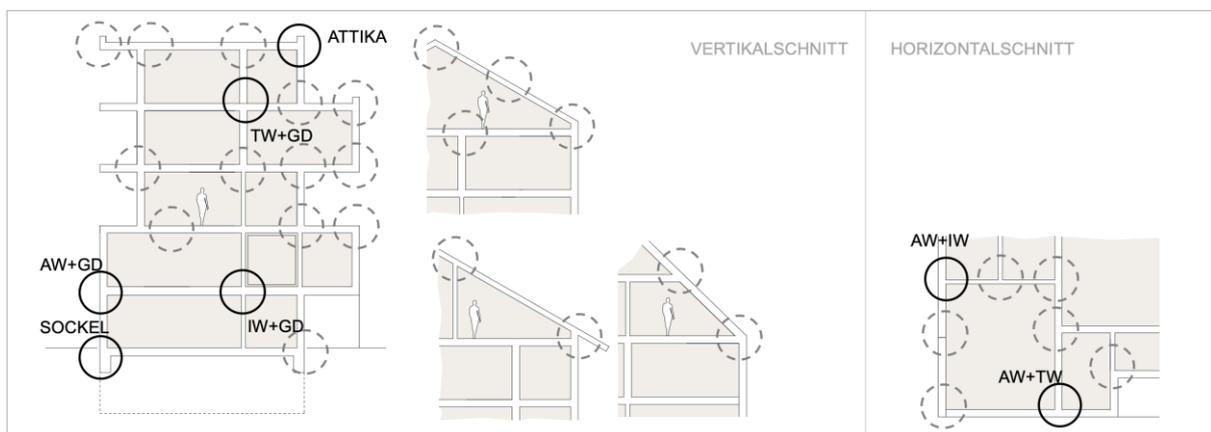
Ausgewählte (schwarz) und zukünftig noch zu bearbeitende Detailpunkte (grau) in Schnitt und Grundriss, Quelle: Forschungsbericht, Grafik: M. Kohaus
